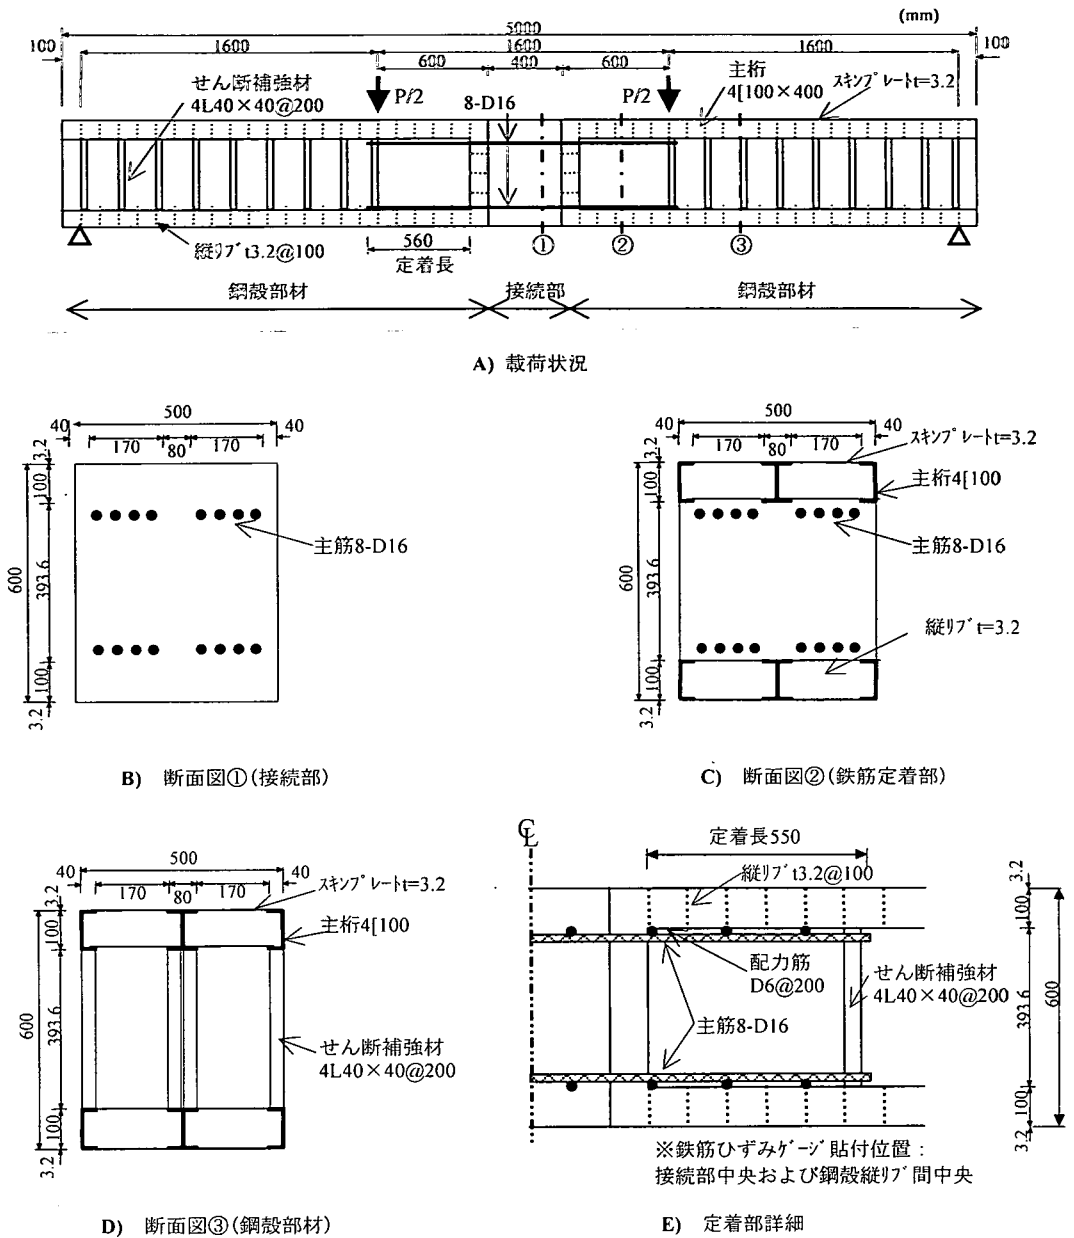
実験供試体の基本構造および載荷状況 (例: 供試体 B-1, 単位 mm)
